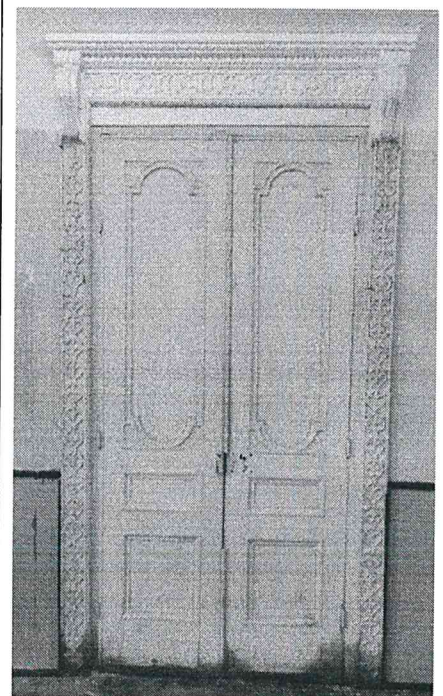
Łukowe obramowanie drzwi elewacji zachodniej.
